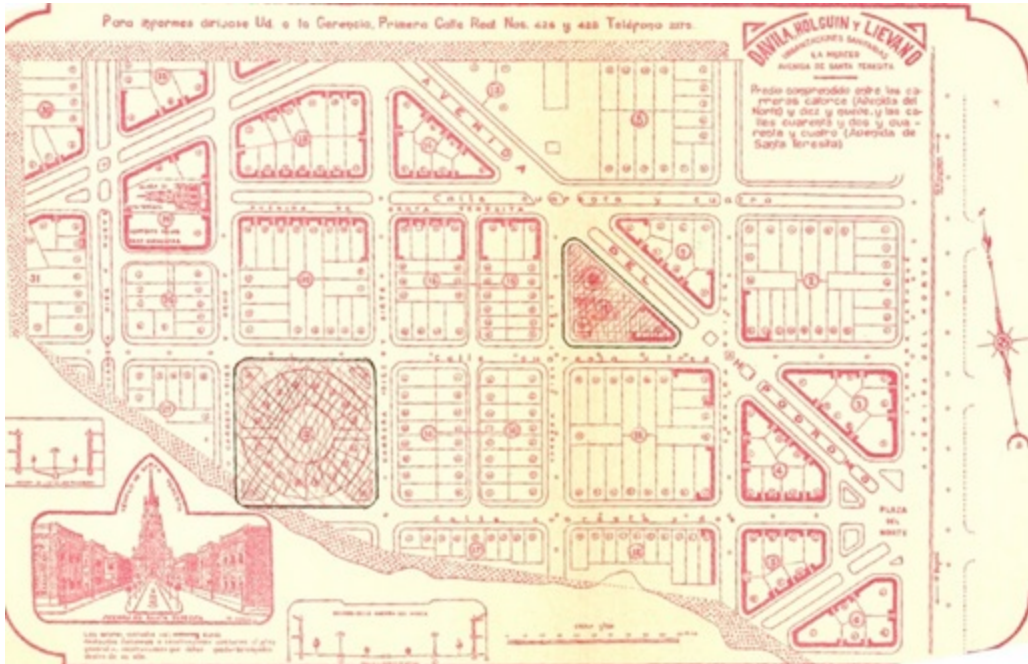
Plano de venta de los lotes de la urbanización de Santa Teresita. C.A. 1928
